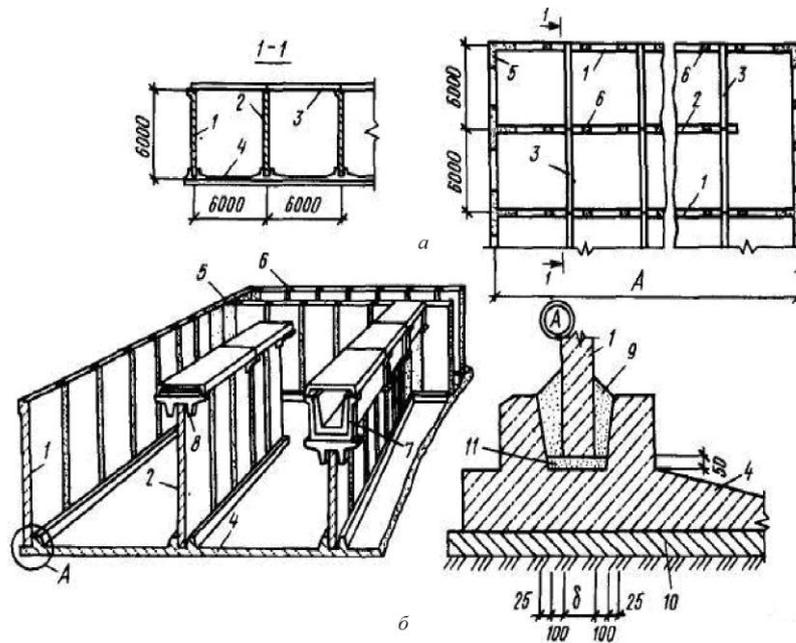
Конструктивное решение аэротенка из железобетонных панелей:
